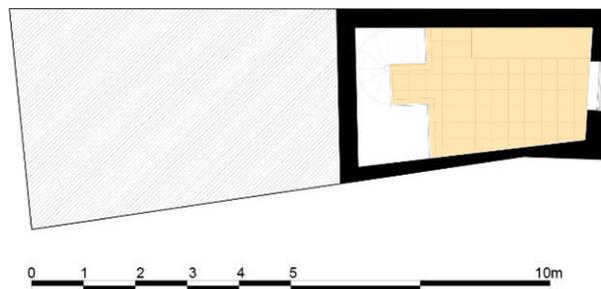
Planta baixa do piso 1 da loja 1, com identificação esquemática das diferentes cotas
